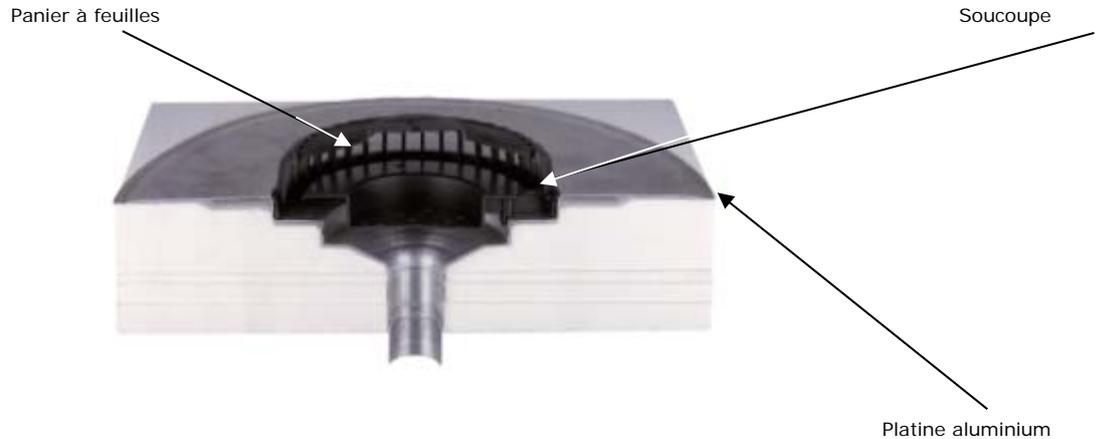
Coupe sur la naissance VACURAIN® associée à un revêtement d'étanchéité bitumineuse
